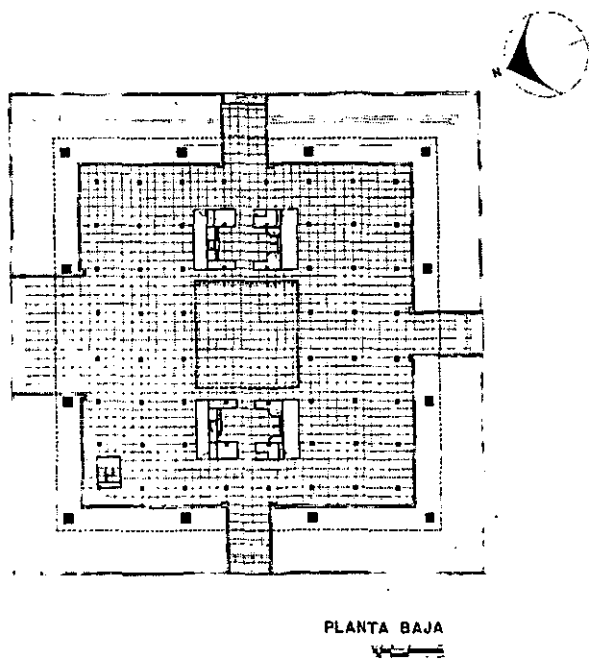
Palacio de Gobierno, planta baja (AOV).
